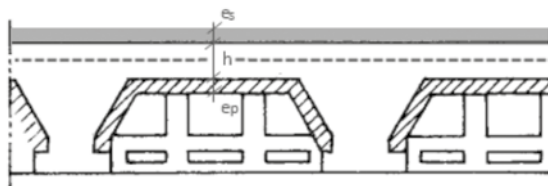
Épaisseur prise en compte dans le critère d'isolation
